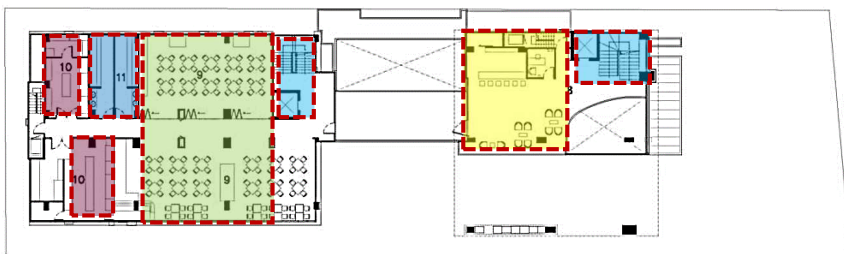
Plan 2eme étage srinakaran hotel traité par l'auteur
